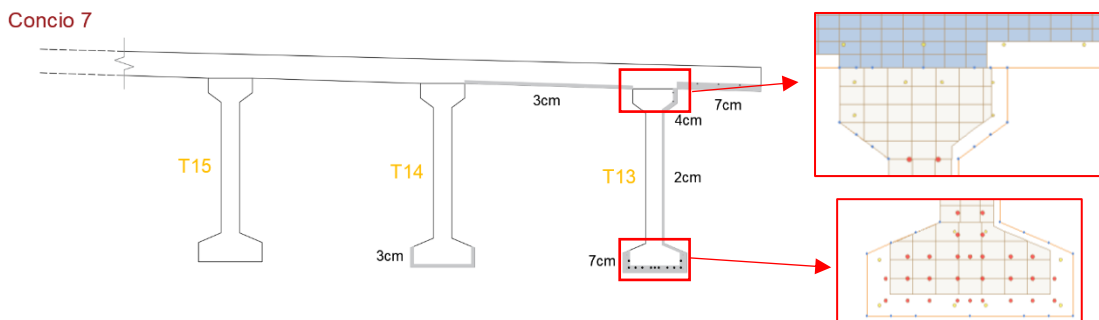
Ponte sul torrente Mavigliano, Caso I_ev3 sezione trasversale Concio 7 + dettagli Midas Civil
